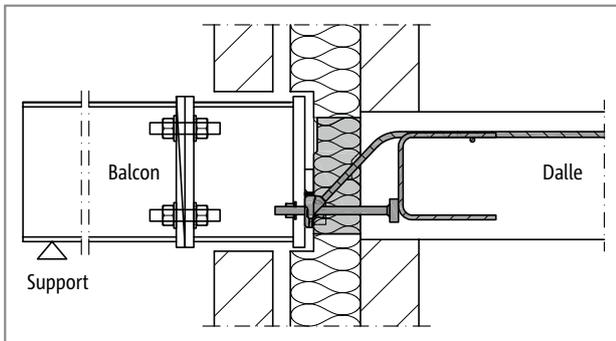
Schöck Isokorb® T type SQ : Corps isolant dans l'isolation du noyau ; la pièce de liaison sur site entre l'élément Isokorb® et le balcon permet une certaine flexibilité dans le processus de construction
